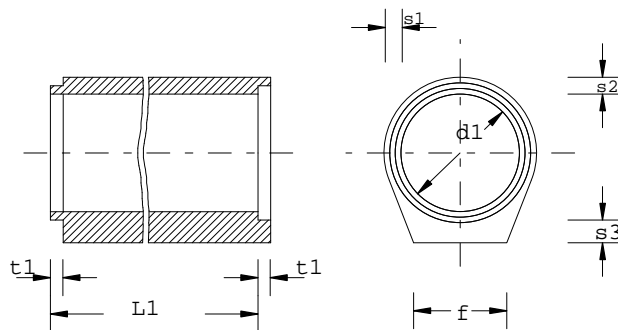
tubi in calcestruzzo di sezione circolare con giunto a risega e piede
